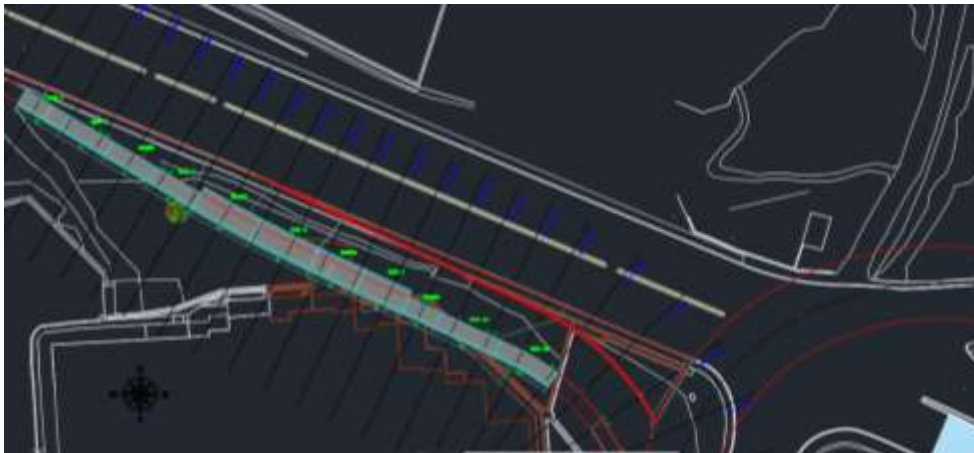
Planos muros anclados alto viento, fuente propia.
